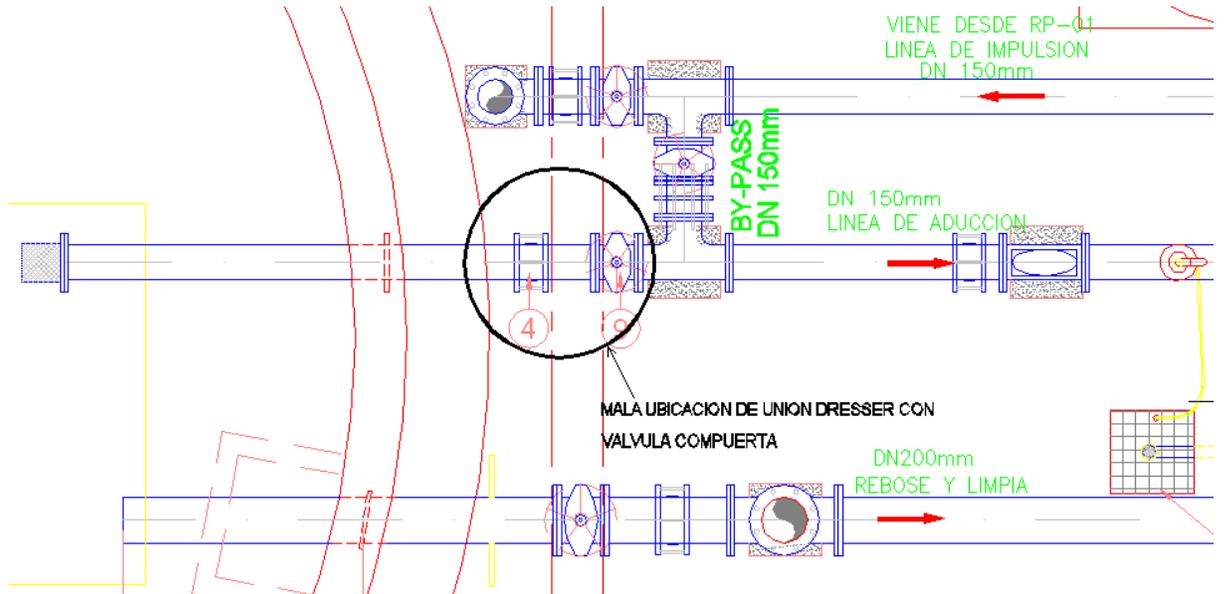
Vista de planta en el plano de proyecto reservorio RP-02 Tambo Viejo Cieneguilla
